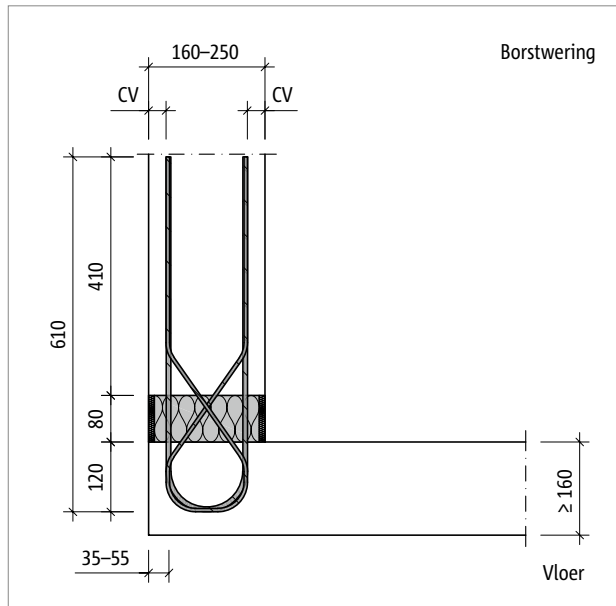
Schöck Isokorb® T type A: Aanzicht randafstanden
